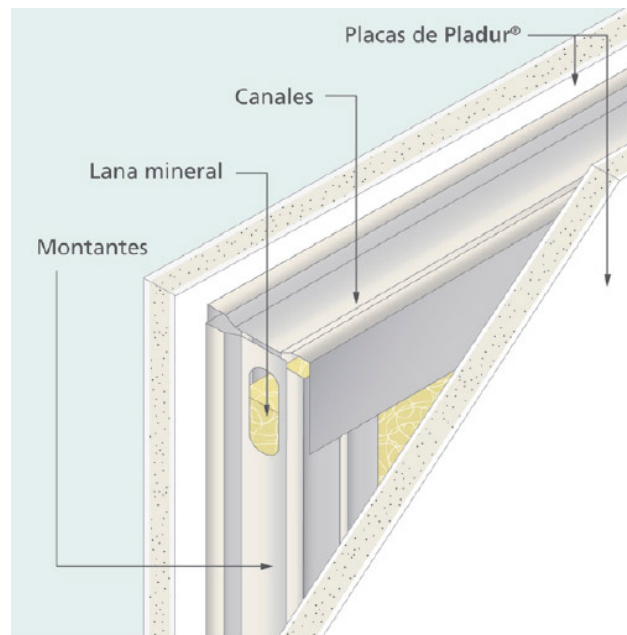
Ejemplo de estructura metálica para colocación de paneles de cartón-yeso
